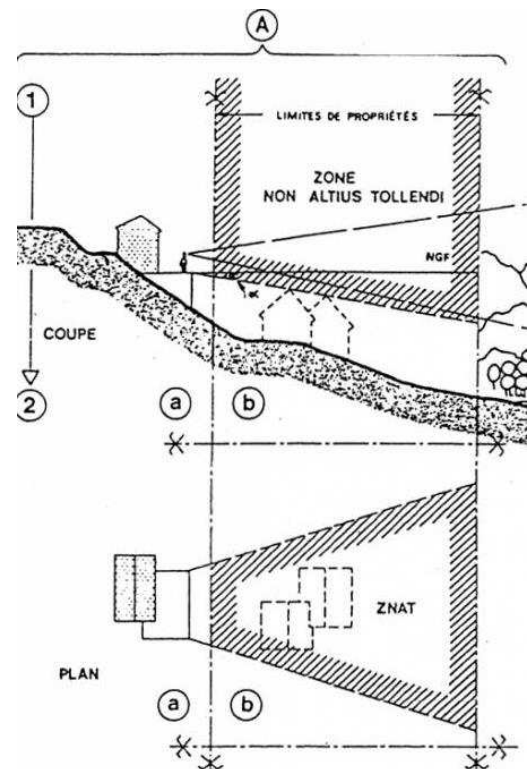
Coupe et vue en plan d'une servitude non altius tollendi
